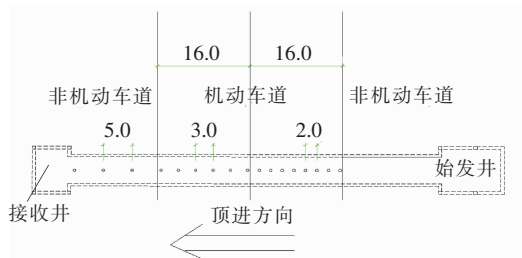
施工平面位置(含顶管上方土体沉降观测点平面布置)
